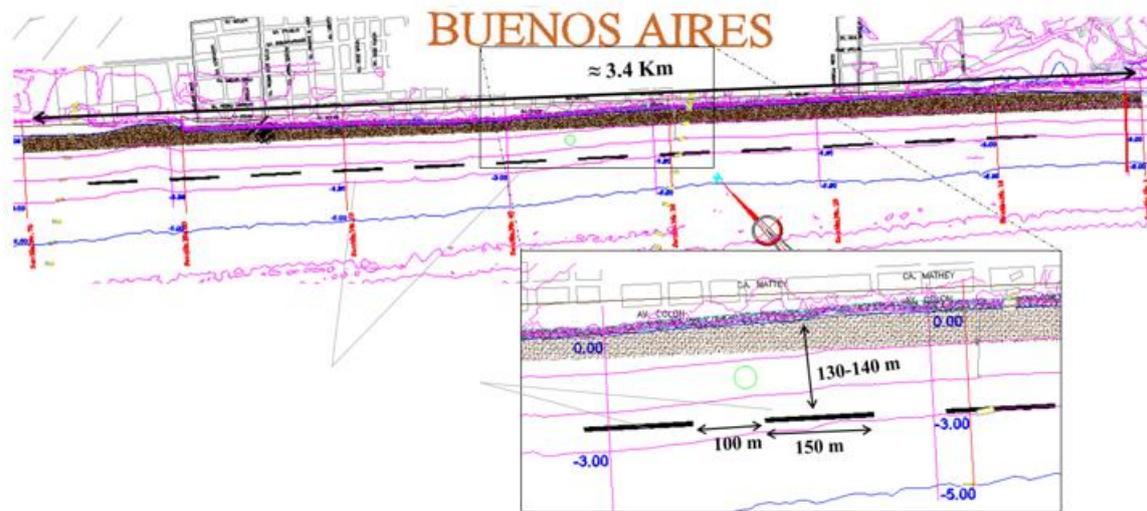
Esquema de la ubicación en planta de la batería de rompeolas diseñada para el balneario de Buenos Aires.
